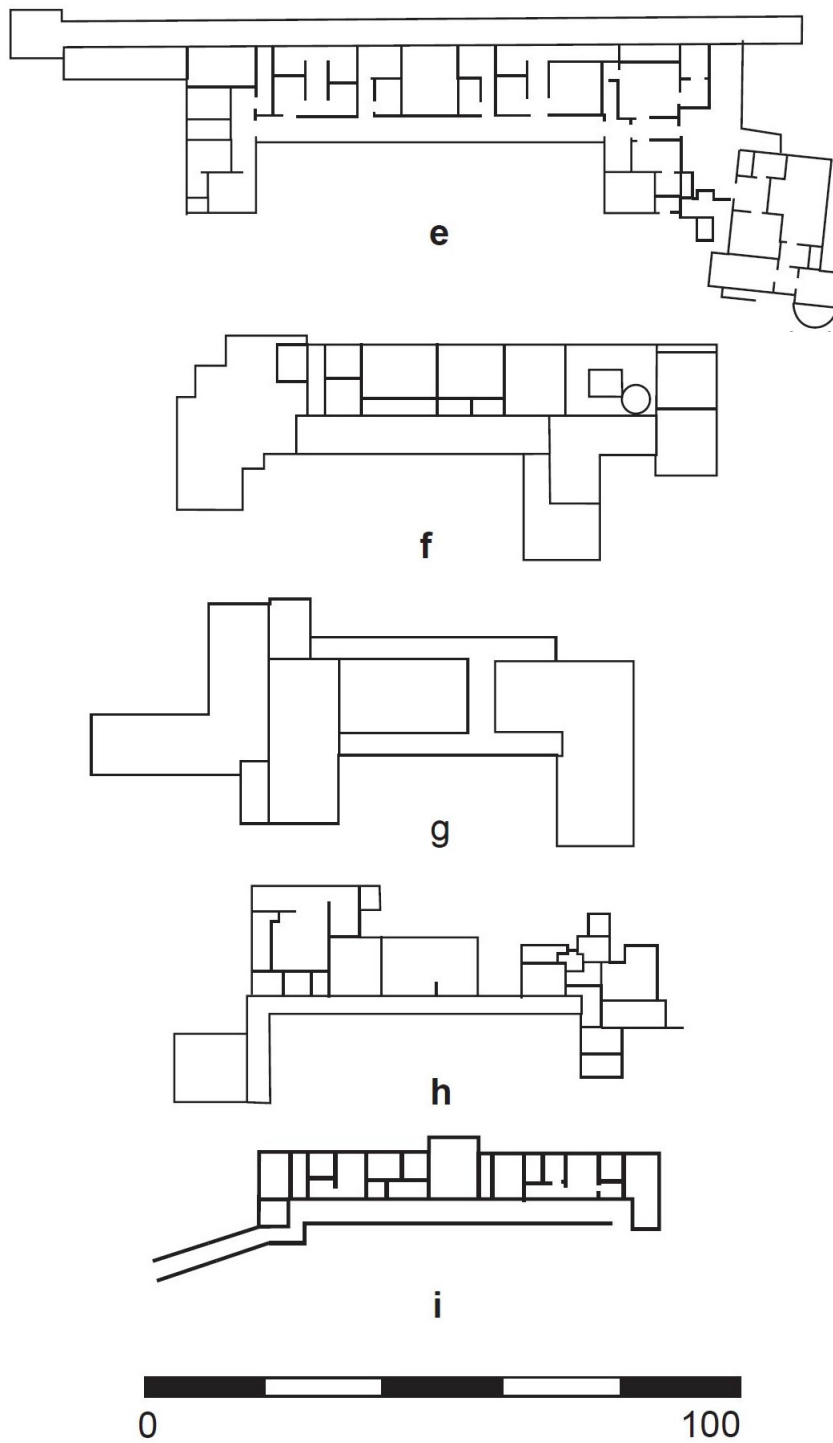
Grundrissvergleich von Hauptgebäuden in Axialanlagen.
